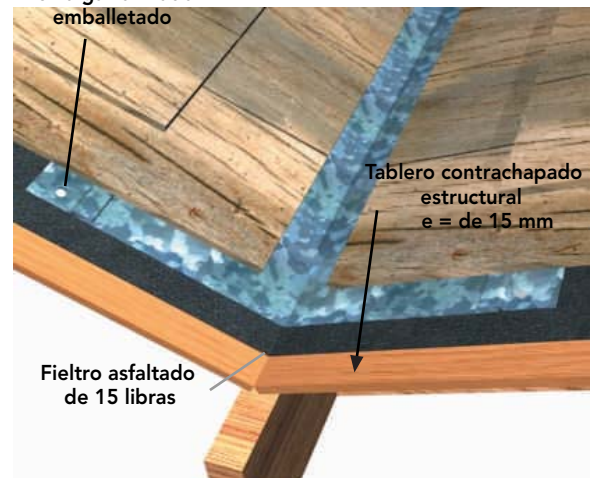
35B: Solución de limahoya, para cubierta de tejuela sobre tablero estructural.
